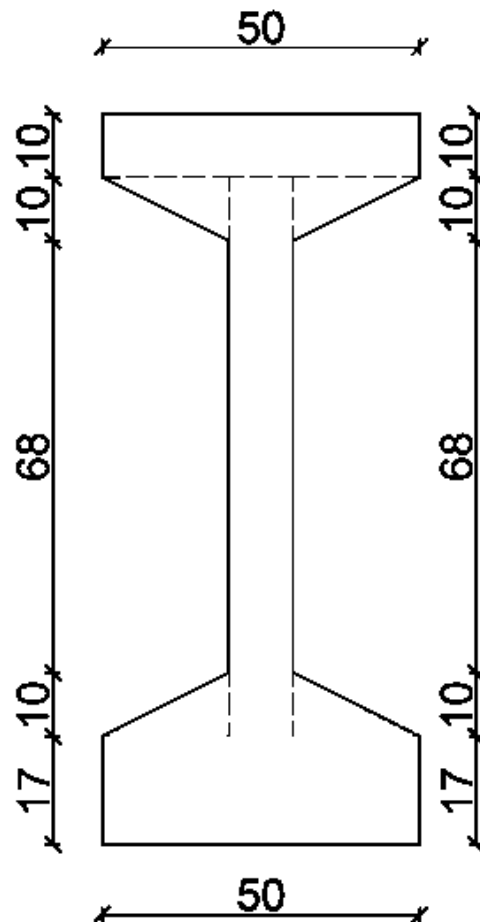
Sección transversal de pila tipo 1; Unidades en centímetros;
